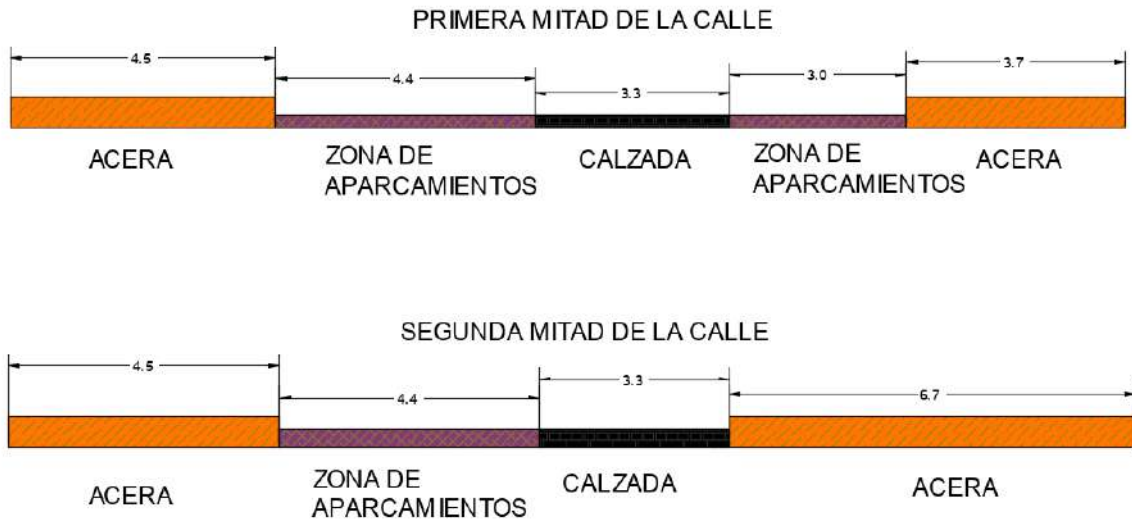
Sección tipo de como quedaría la calle transversalmente. Fuente: Elaboración Propia.
